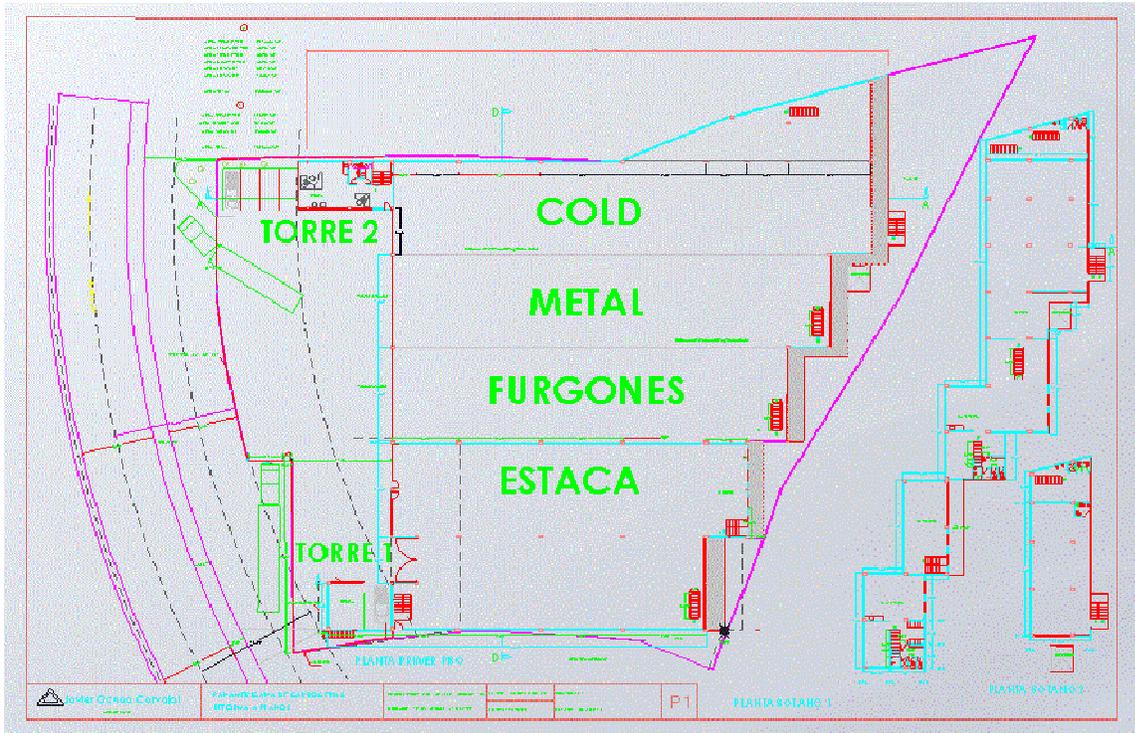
Plano de la planta Carrocerías Panamericana S.A.S.
